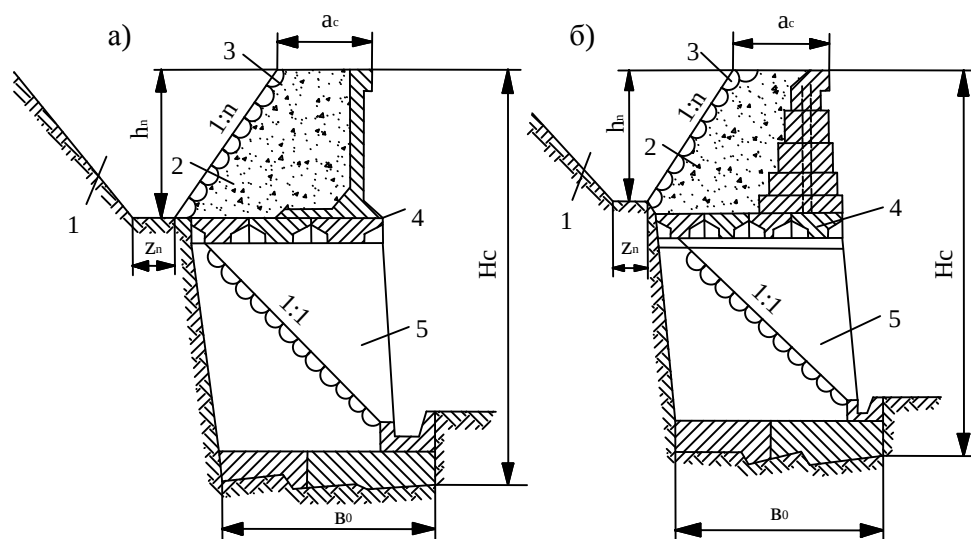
Конструкции противообвальных улавливающих стен (сборно-монолитные): *а* — двухъярусная стена с устройством верхнего яруса из сборного железобетона углового профиля; *б*—двухъярусная стена с устройством верхнего яруса из бетонных блоков; 1—улавливающая пазуха; 2—амортизирующая отсыпка; 3—выкладка откоса крупным камнем; 4—железобетонные блоки перекрытия; 5—контрфорсы из монолитного бетона
